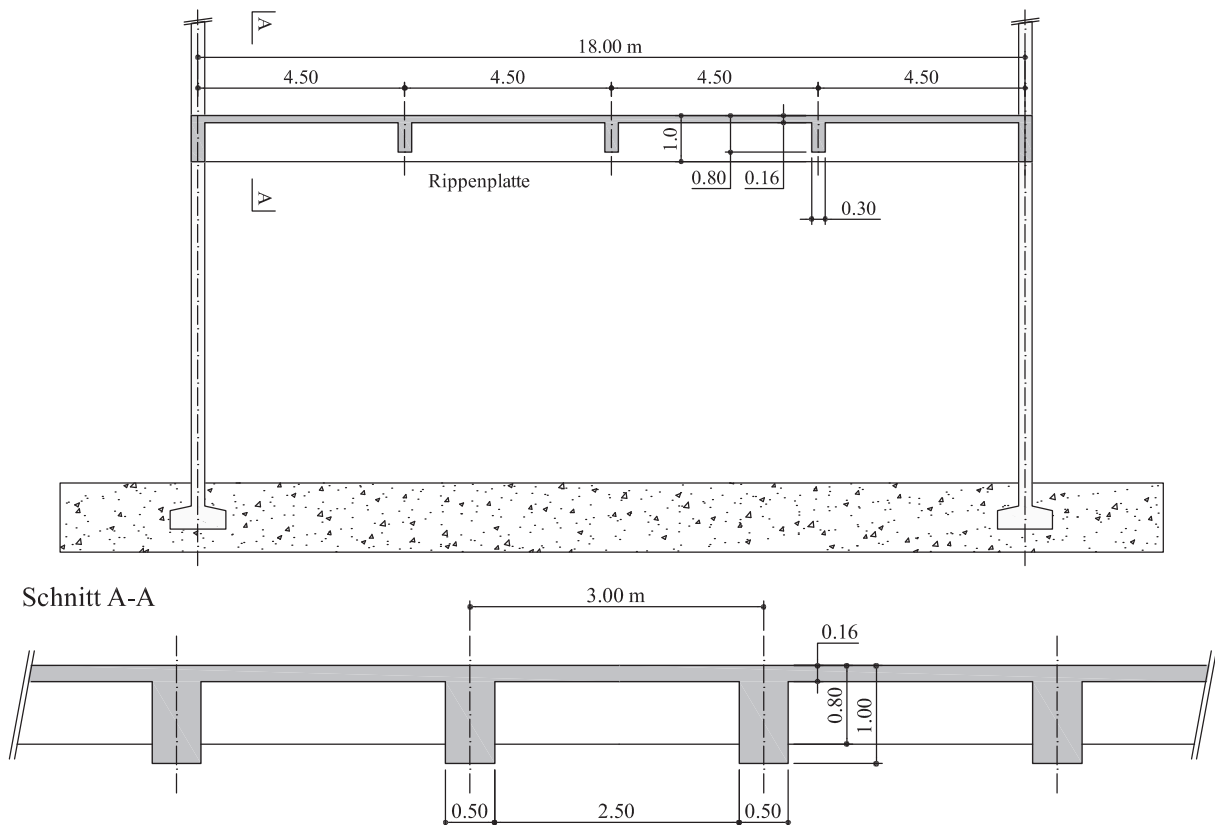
Ansicht einer doppelstöckigen Turnhalle (oben) und Schnitt durch den Hauptträger (unten).
